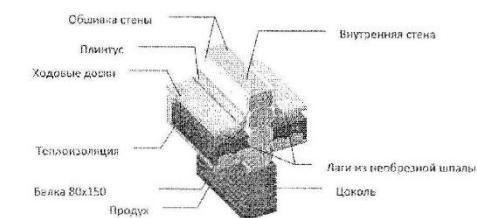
Конструкция перекрытий в домах с бревенчатыми стенами
